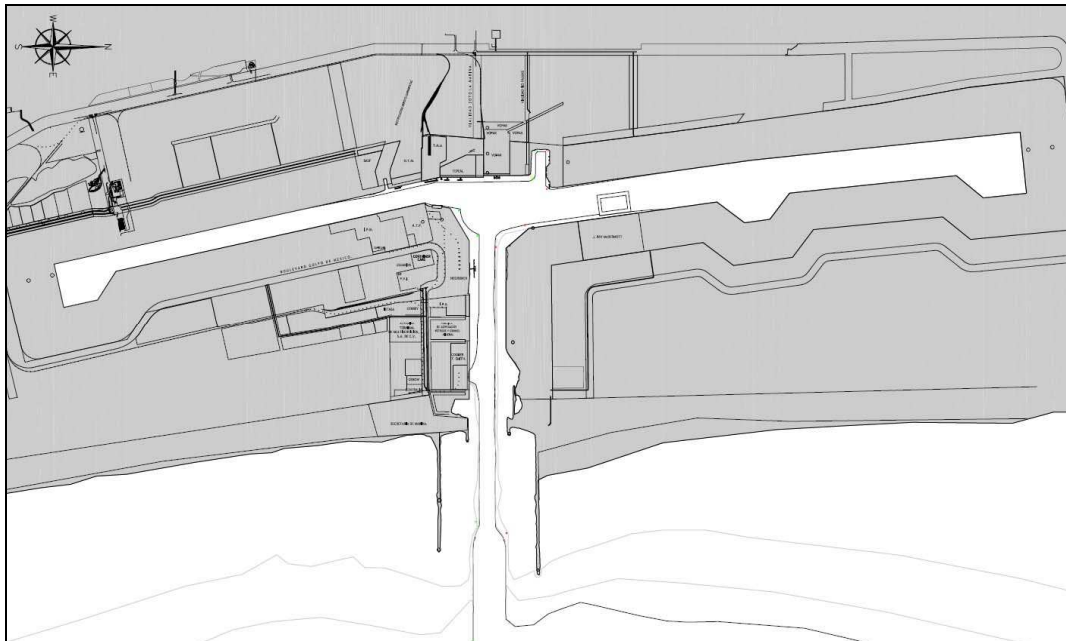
Configuração em planta do futuro Porto de Altamira. México
